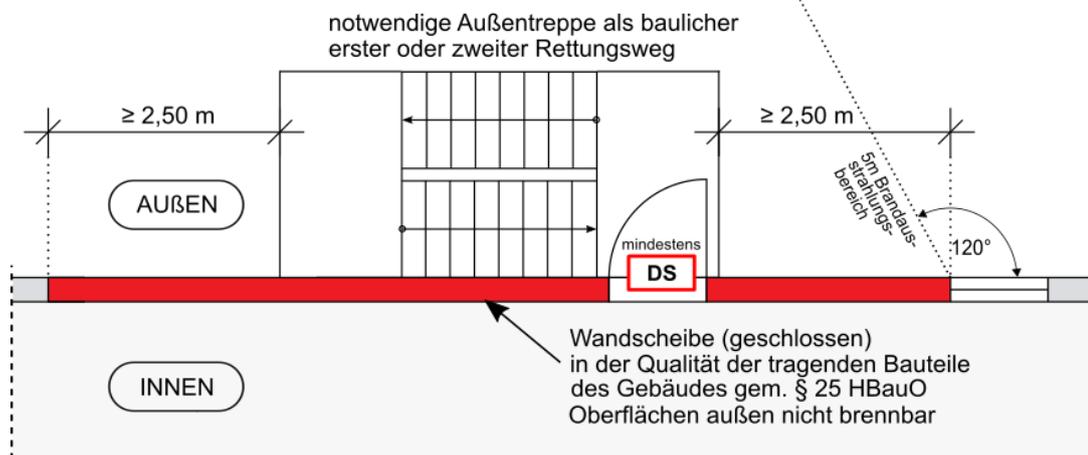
Prinzipskizze (Grundriss) - notwendige Außentreppe als baulicher 1./2. Rettungsweg
